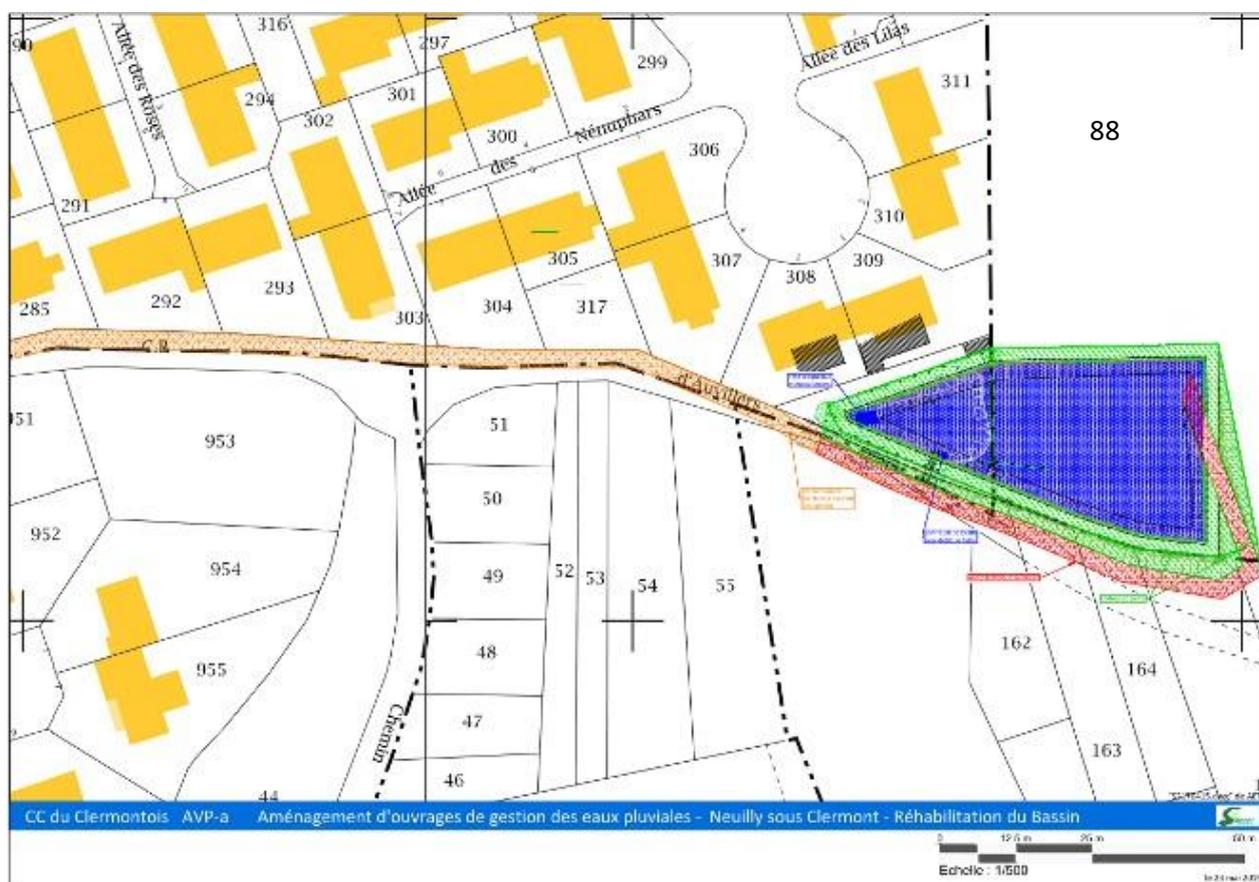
Projet projeté sur le plan cadastral (Source : SODEREF)
